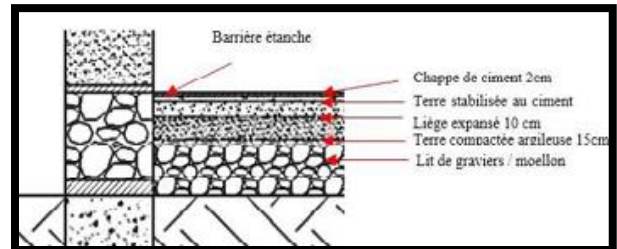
Détails constructif plancher terre-ciment au niveau de sol.
